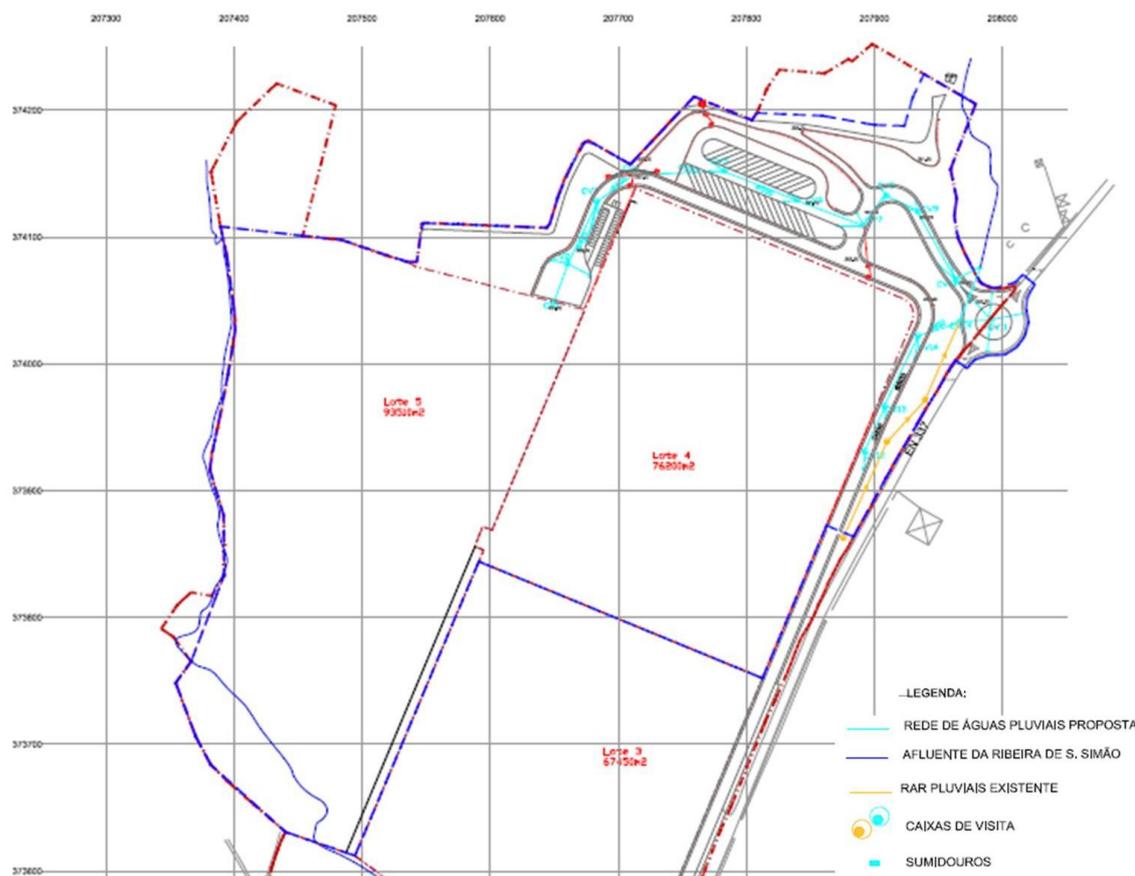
Extrato da planta do projeto de execução relativo à “Drenagem Pública de Águas Pluviais” (adaptado do Anexo III)
